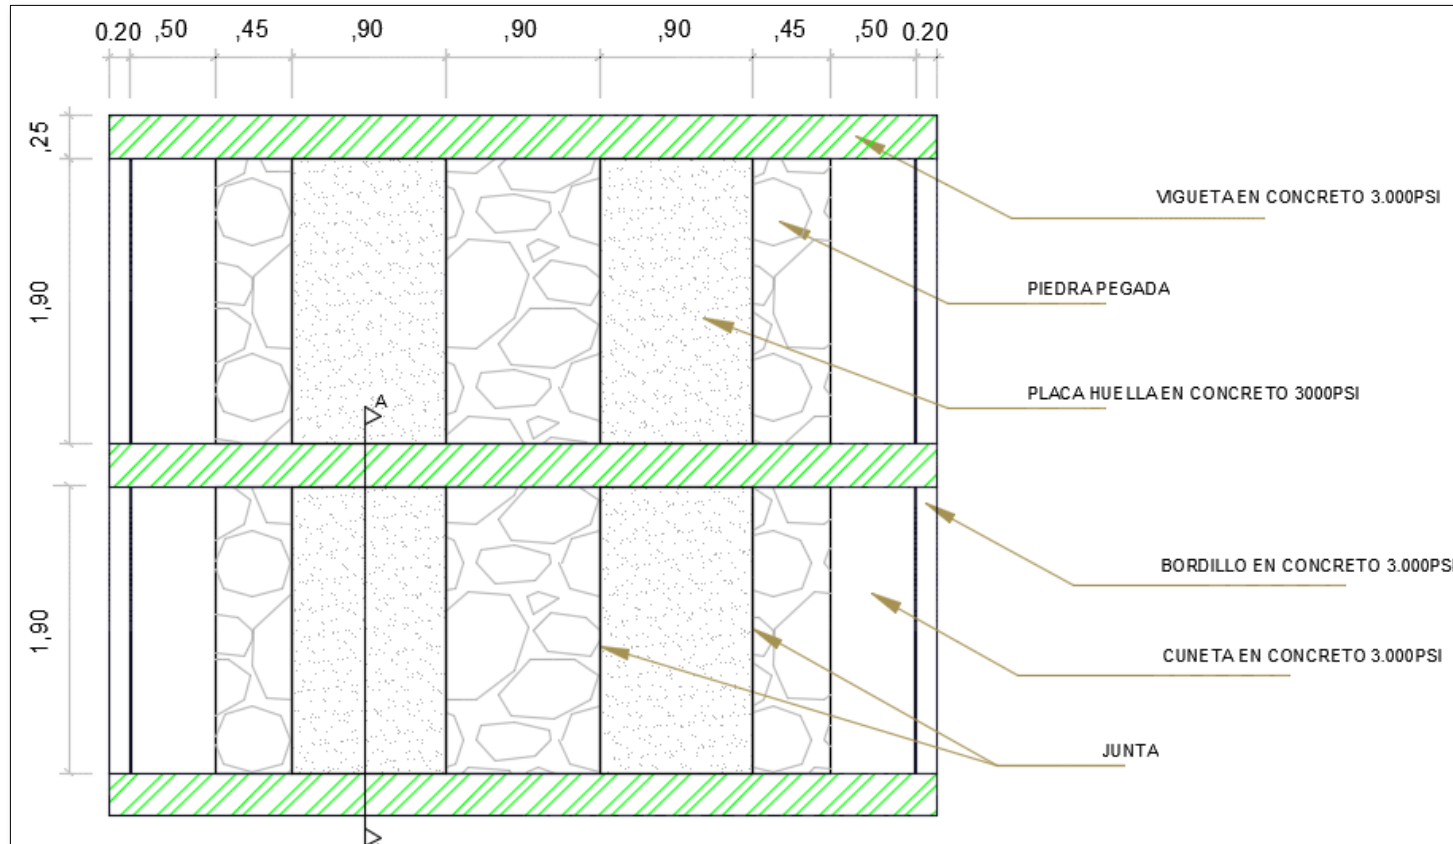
Sección Típica en Planta. Placa Huella Para un Carril de Circulación.
